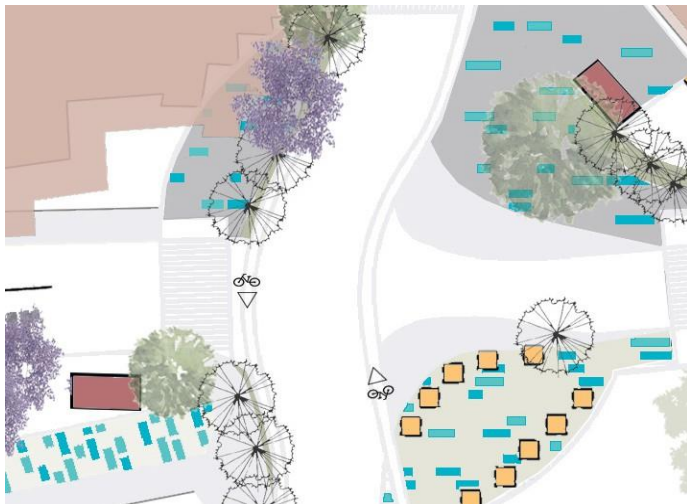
Planta del nodo del proyecto donde intersectan los cuatro ejes.
